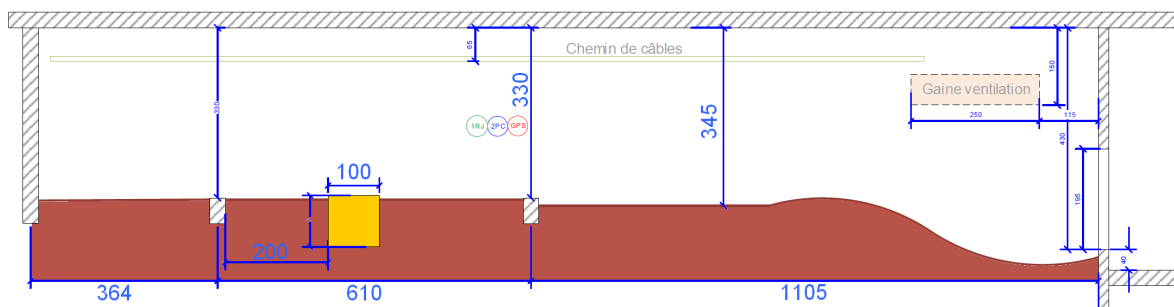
Plan en coupe du vide sanitaire situé sous le bâtiment du site d'Angers du groupe ESEO. L'entrée s'effectue à droite. Mesures exprimées en centimètres. Jaune : dalle de béton. Marron : sol (terre).
